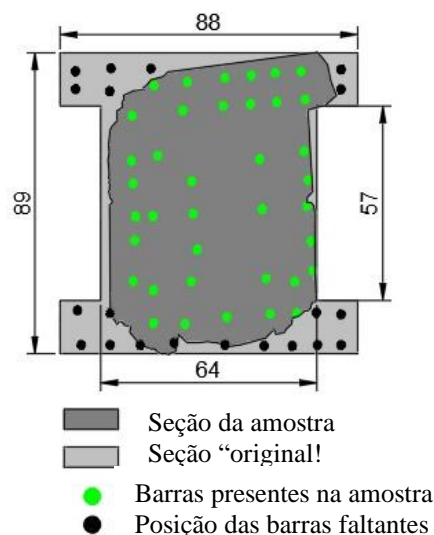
Reconstituição da seção transversal do pilar recuperado dos escombros.
